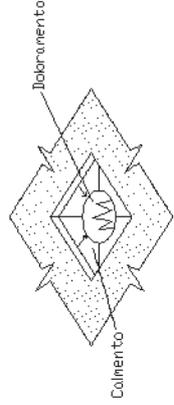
Acabamento dos sistema de impermeabilização junto ao ralo.
